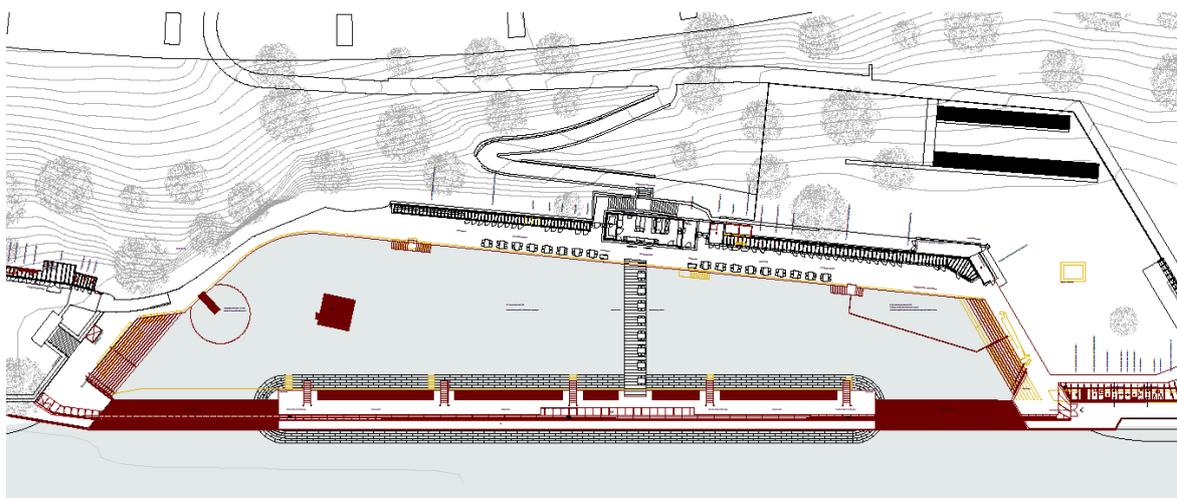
Grundriss Vorprojekt Lorrainebad
